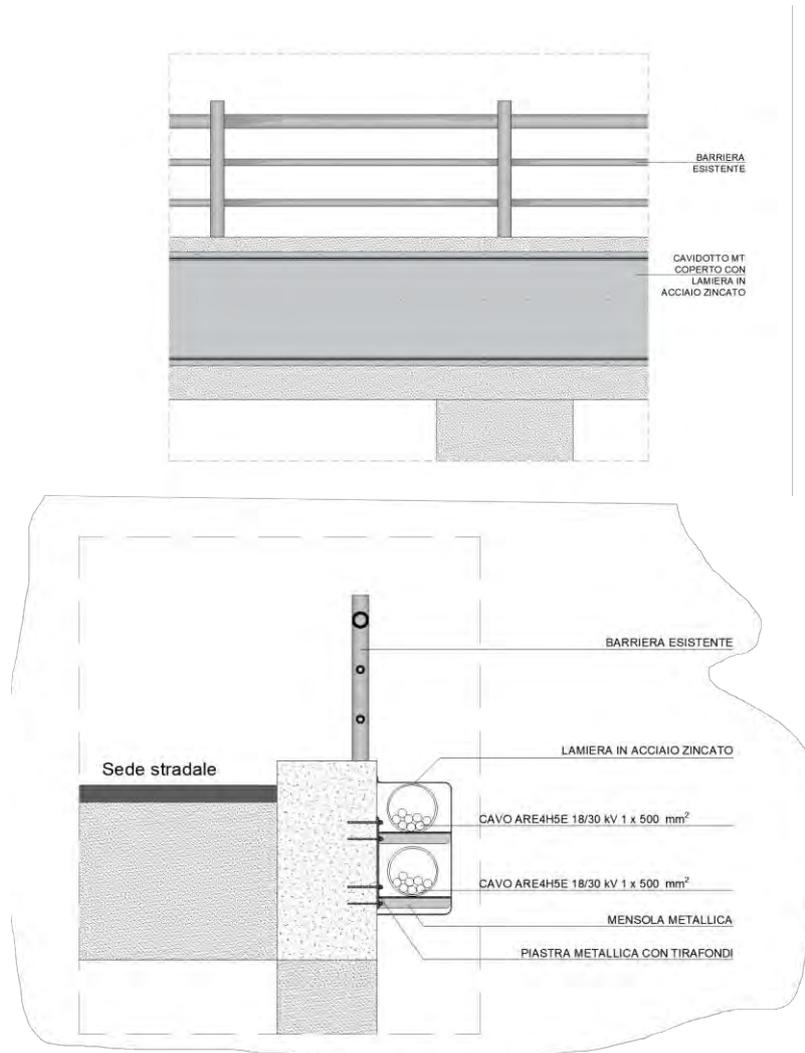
Particolare costruttivo dell'attraversamento del ponte
